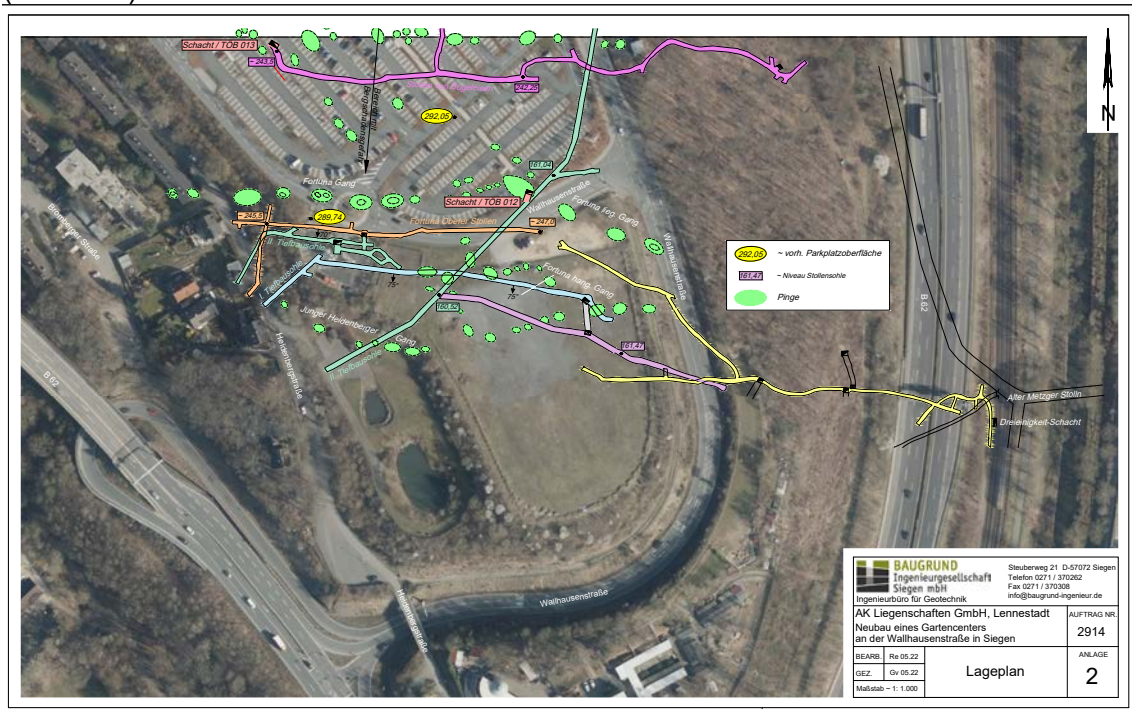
Untertägiger und oberflächennaher Bergbau im Plangebiet
